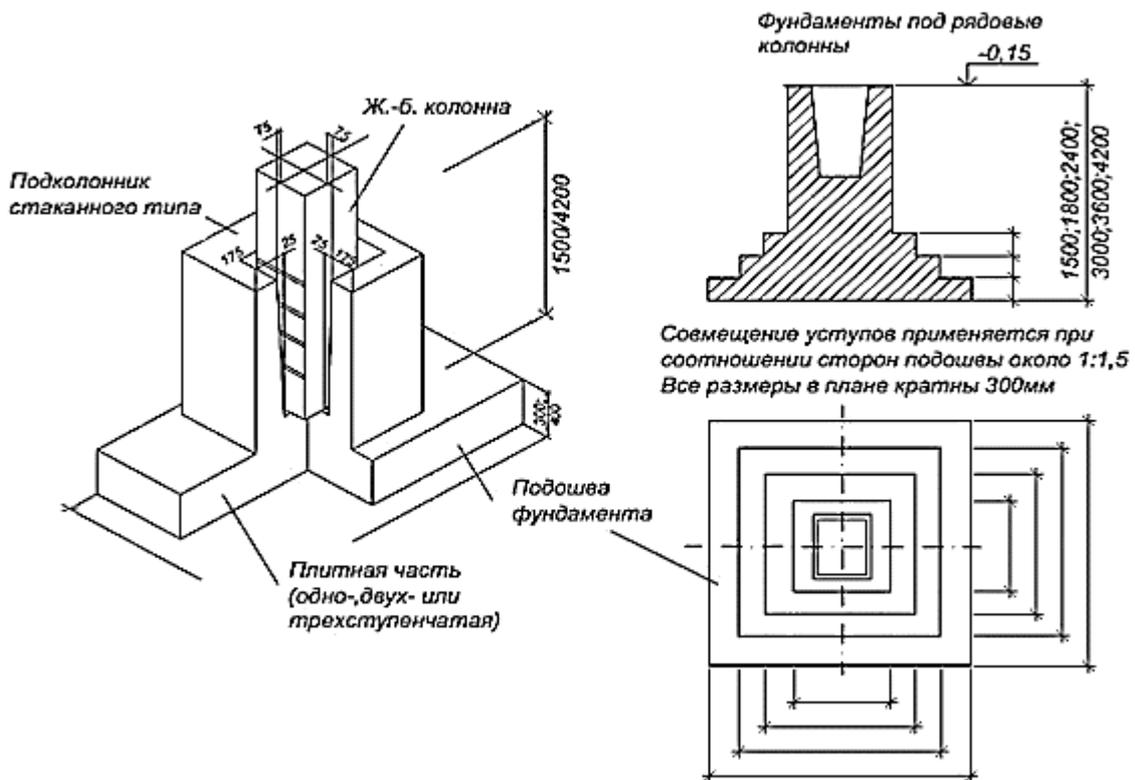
Монолитные железобетонные фундаменты стаканного типа
